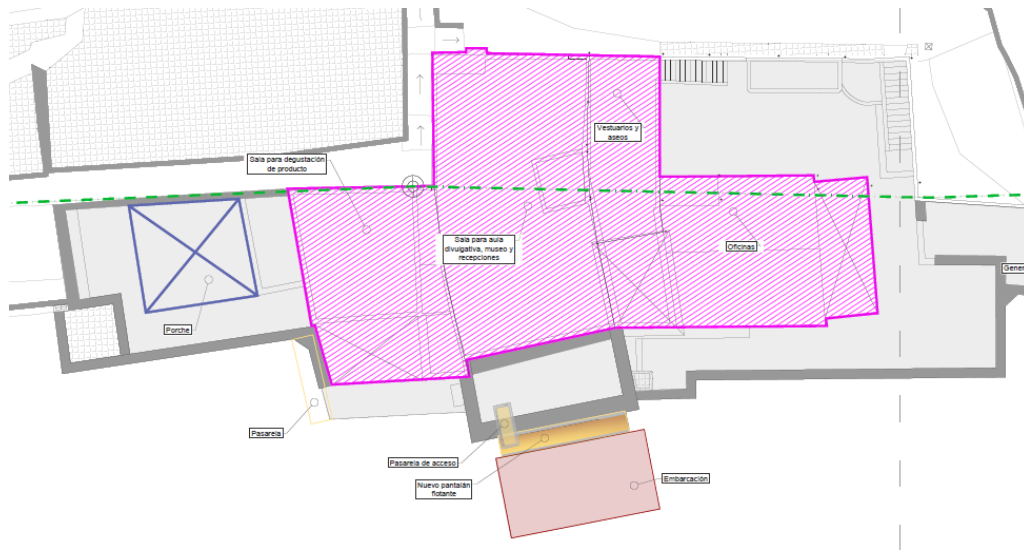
Planta propuesta para la alternativa 1 en el resto de las parcelas.
